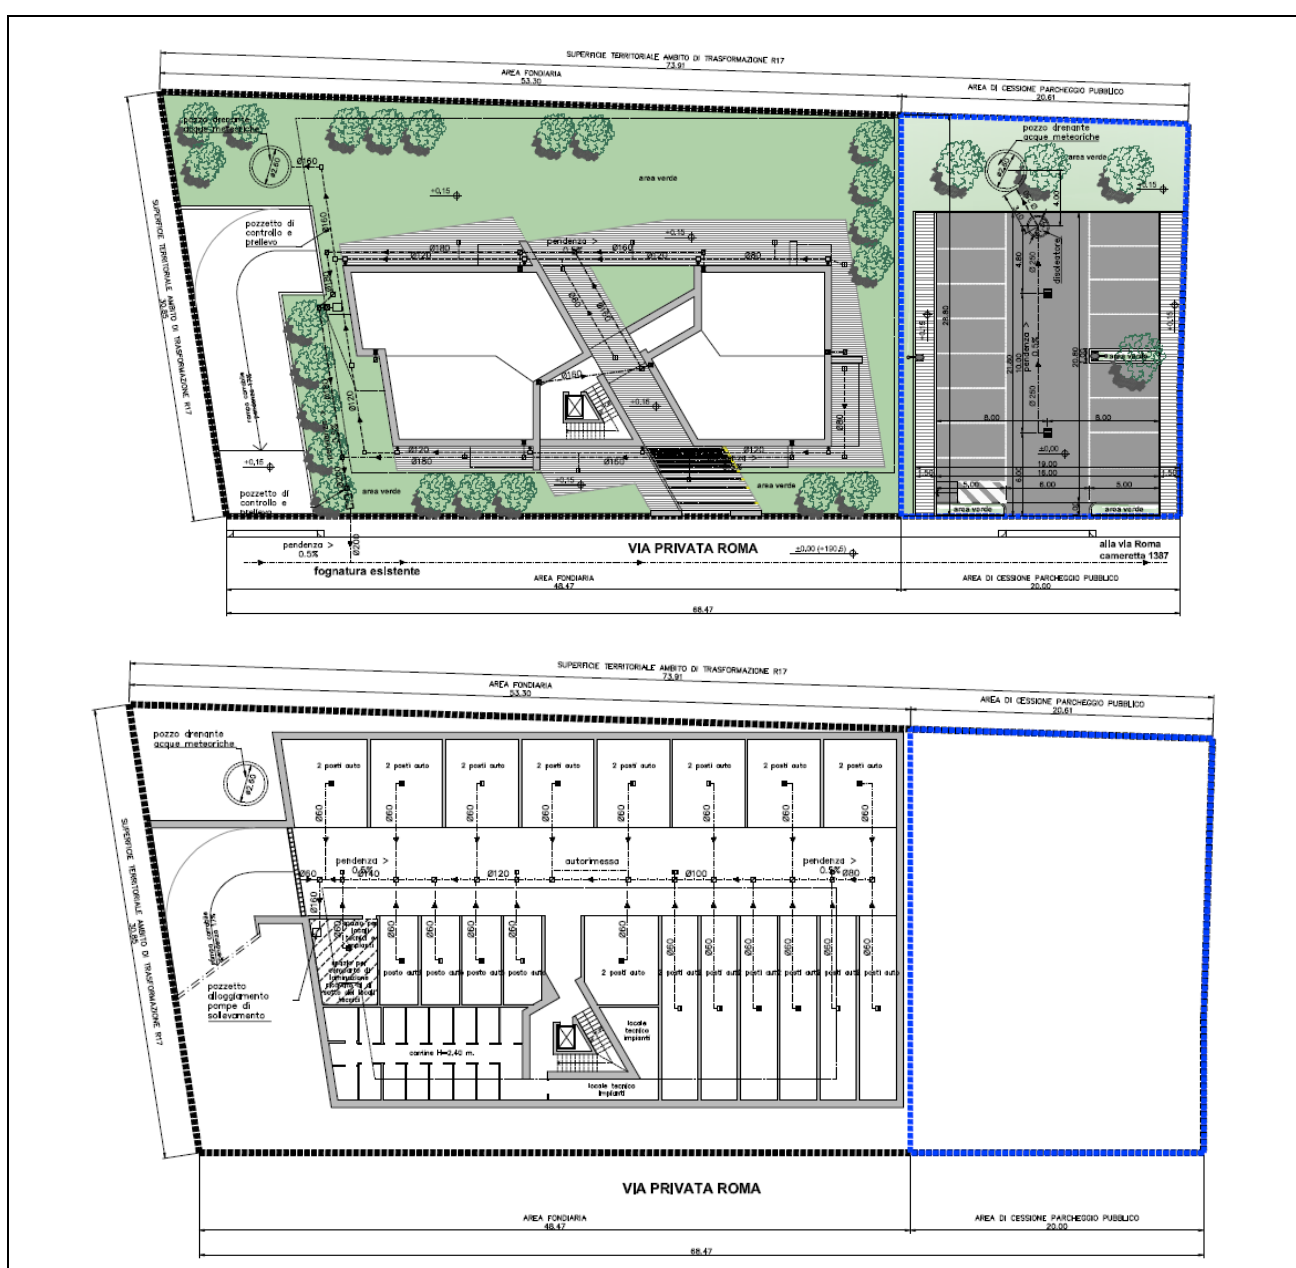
Superficie interessata dall'intervento – Piano terra e piano interrato.
